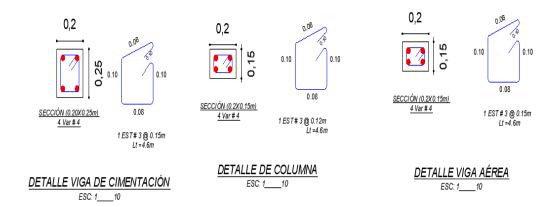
Detalle de viga de columna, cimentación y viga aérea
